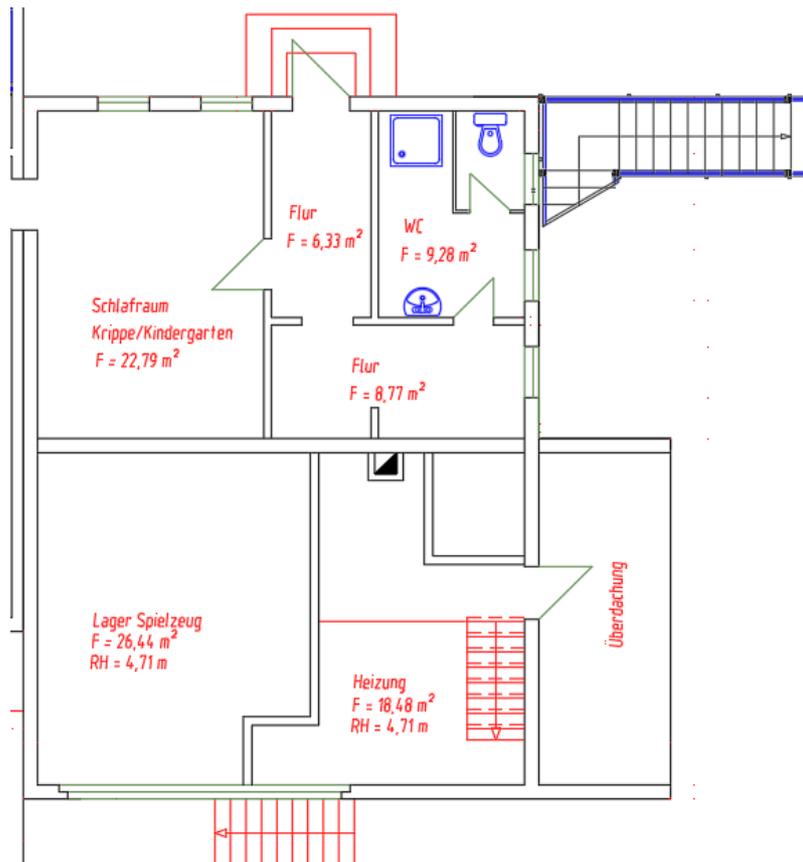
Ausschnitt Grundriss Heizhaus
